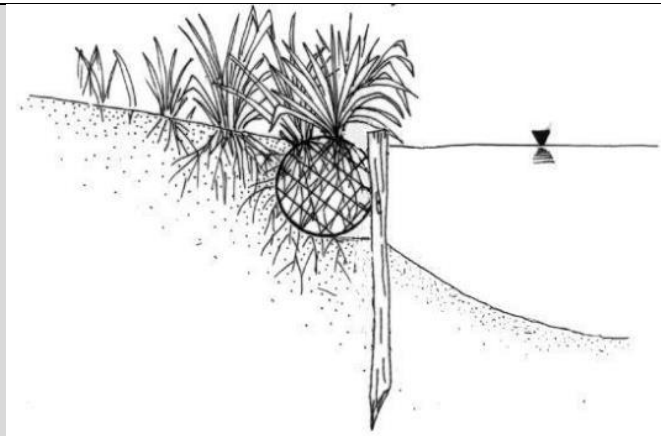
Exemple d'installation des fascines par maintien par pieux
